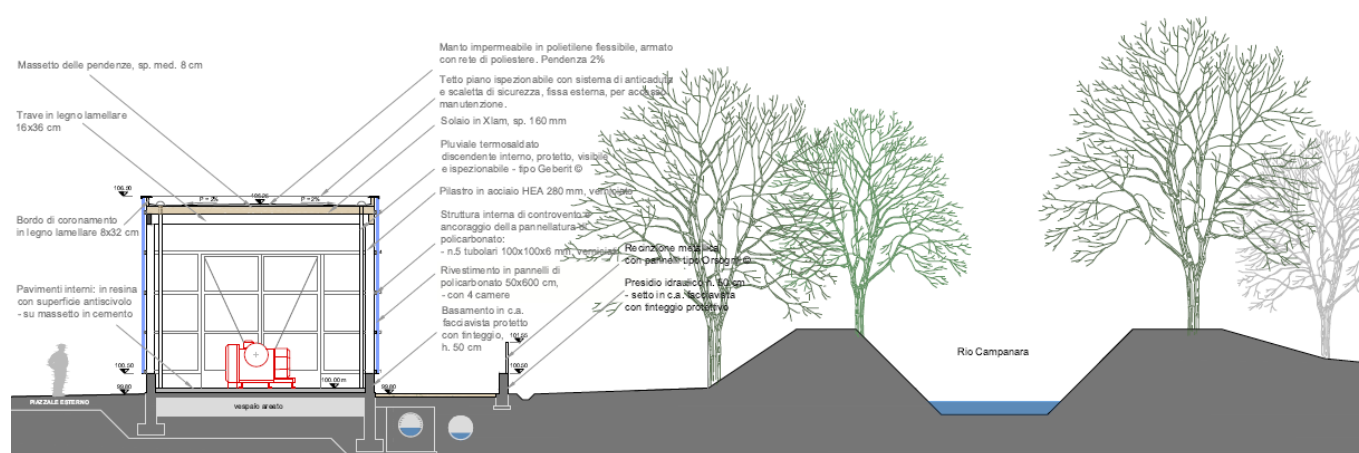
PROSPETTO NORD E SEZIONE TRASVERSALE DELLA CENTRALINA IDROELETTRICA
